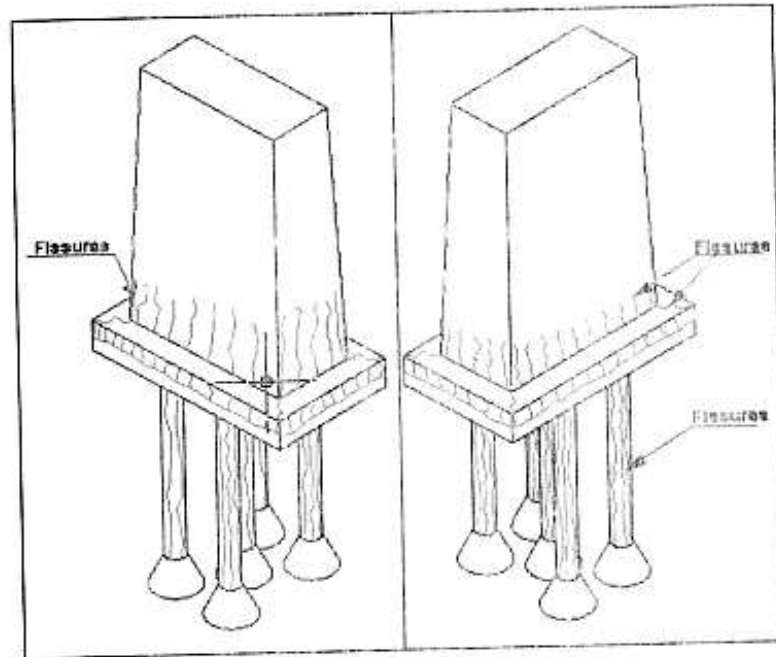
danos observados os elementos submersos da estrutura, pilares, bloco de fundações e tubulões.
